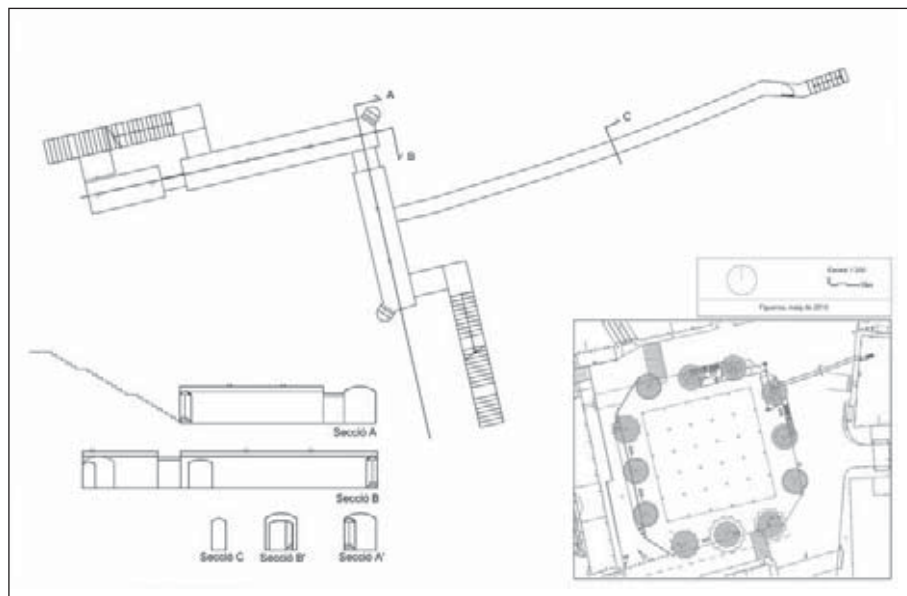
Planta i seccions del refugi descobert l'any 2014 a la plaça de Gra.
